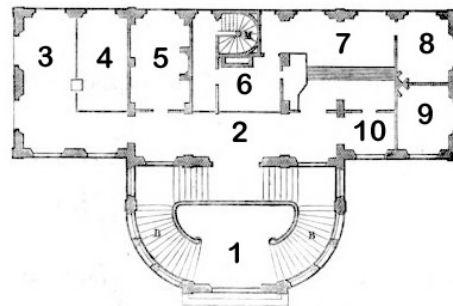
Station de Chelles. Rez-de-chaussée.
